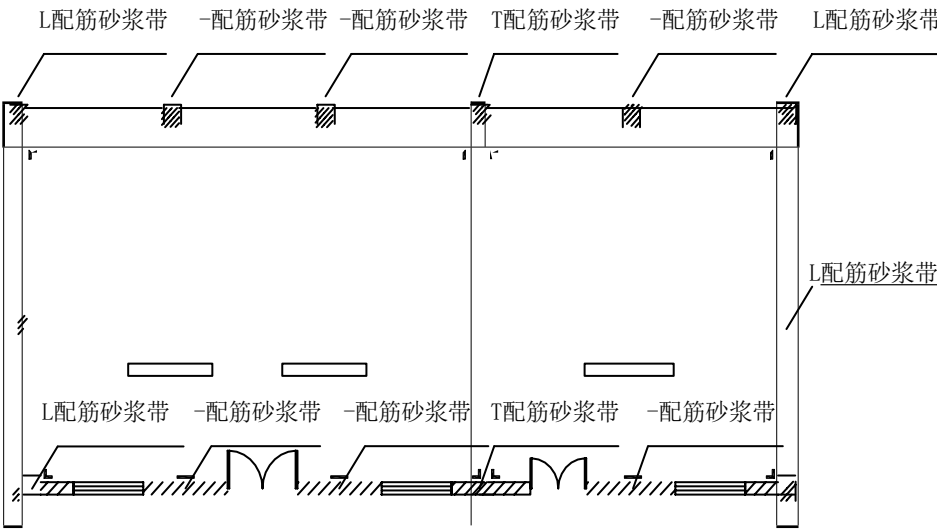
图 6.2.6-2 五间房竖向配筋砂浆带的布置示意图
